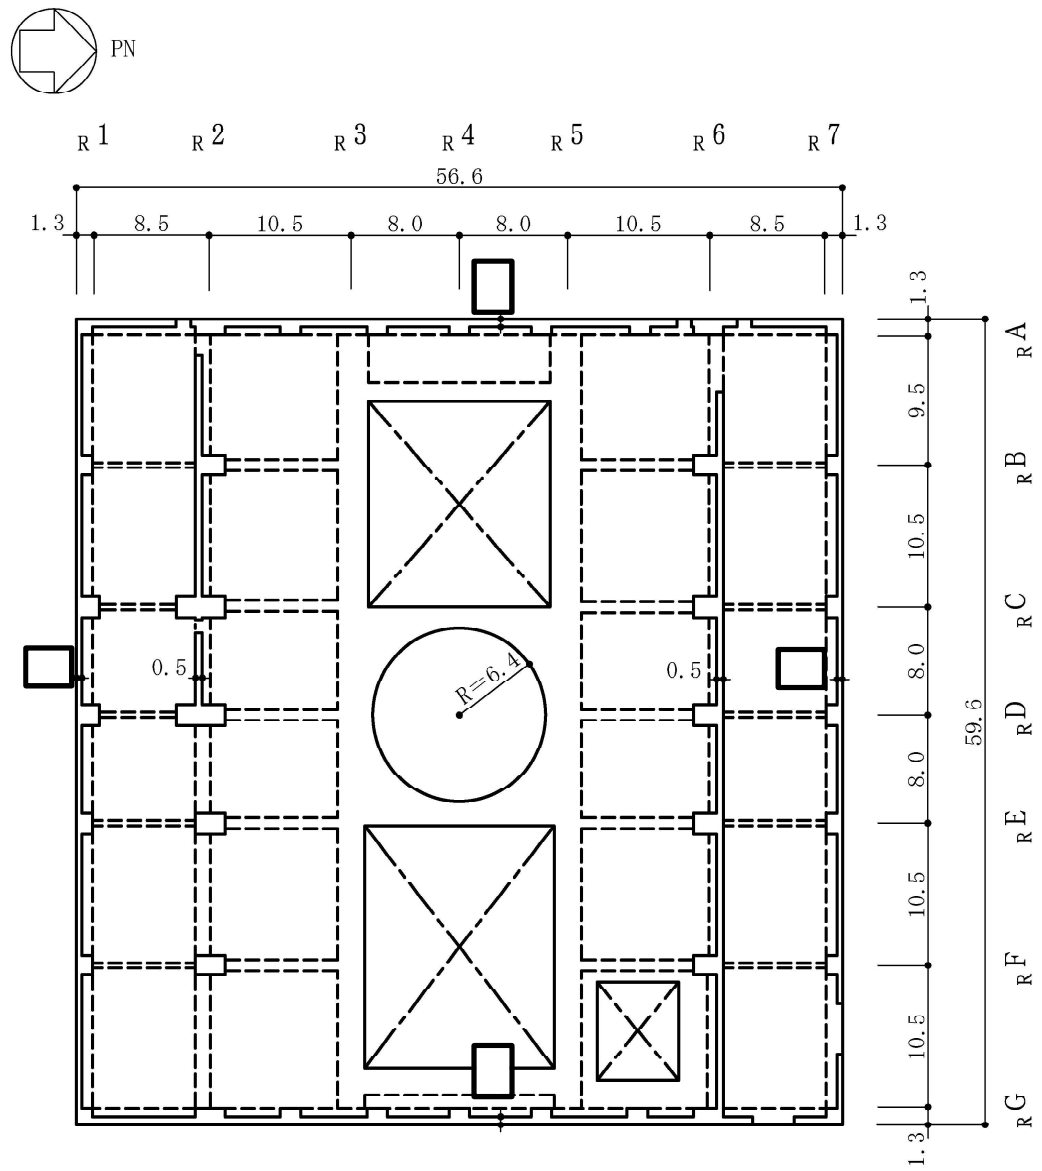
原子炉建屋の概略平面図 (4F, T.M.S.L. 31.7m) (7/9) (単位 : m)
